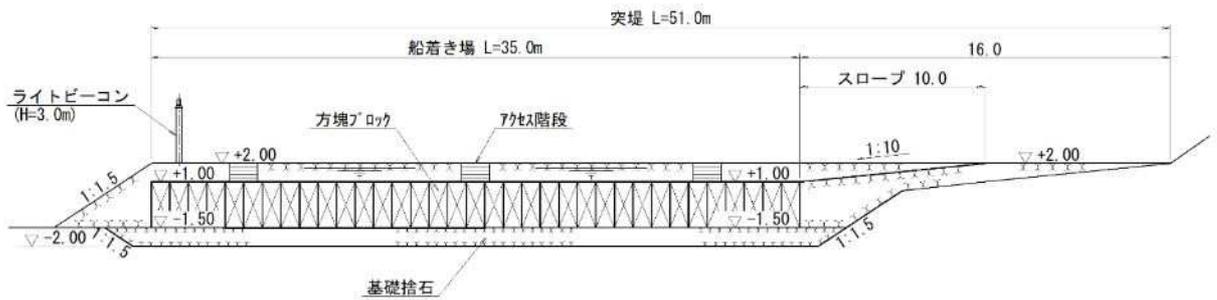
(9) 第2防砂堤(仮設岸壁)の縦断面図
